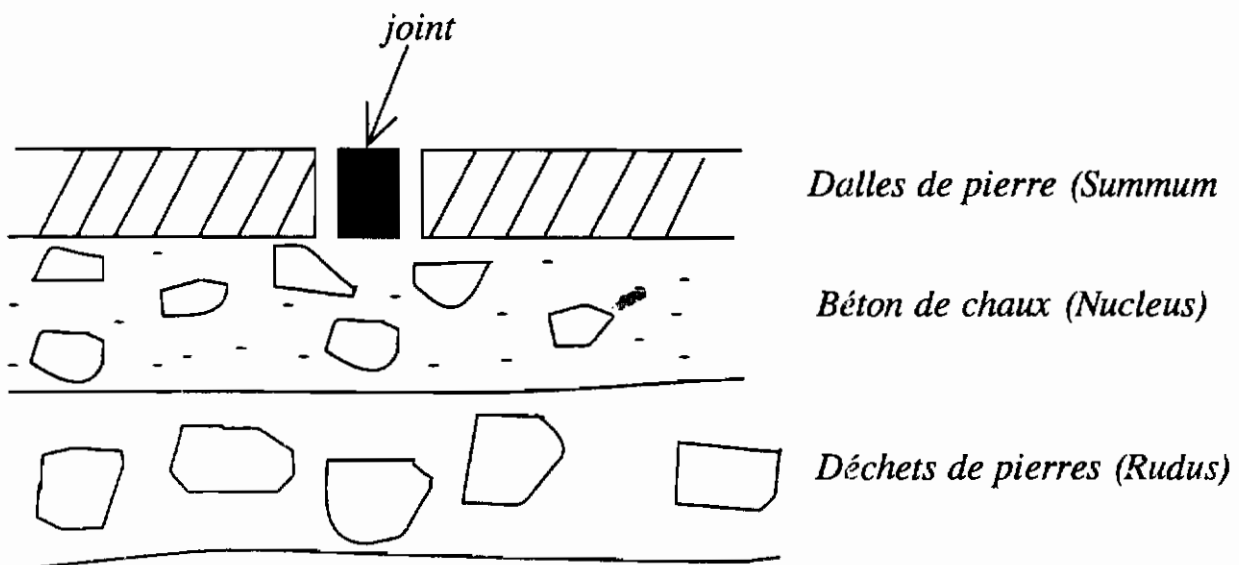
La chaussée romaine : on comparera avec une chaussée en béton moderne (couche de forme, fondation en béton maigre, dalle de revêtement)
